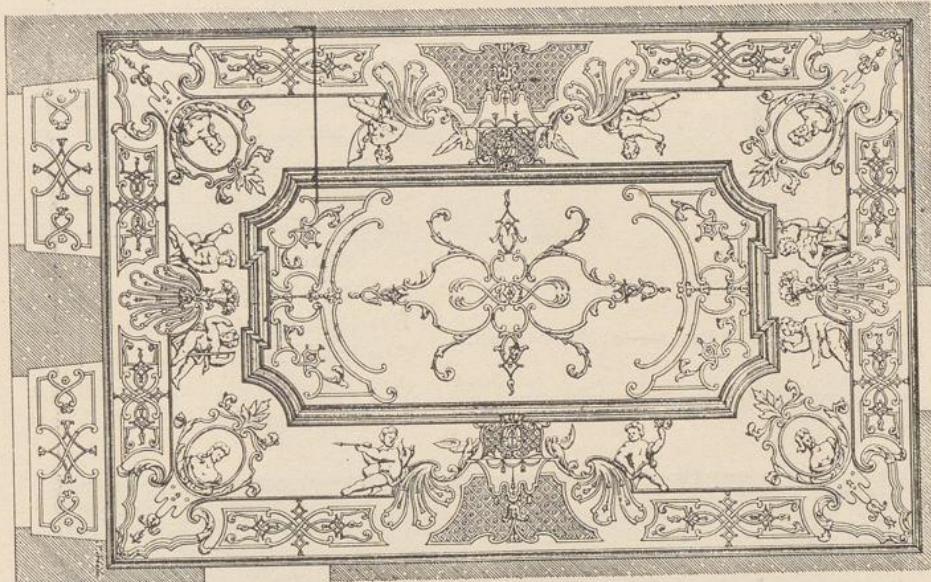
Lichtenstein; Decke im ersten Obergeschoss.
